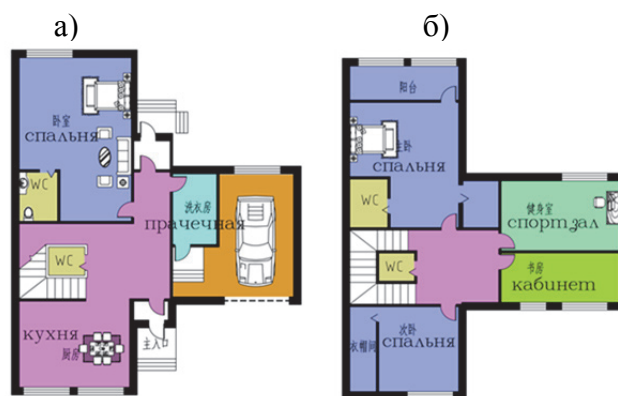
а) План 1 этажа; б) План 2 этажа
